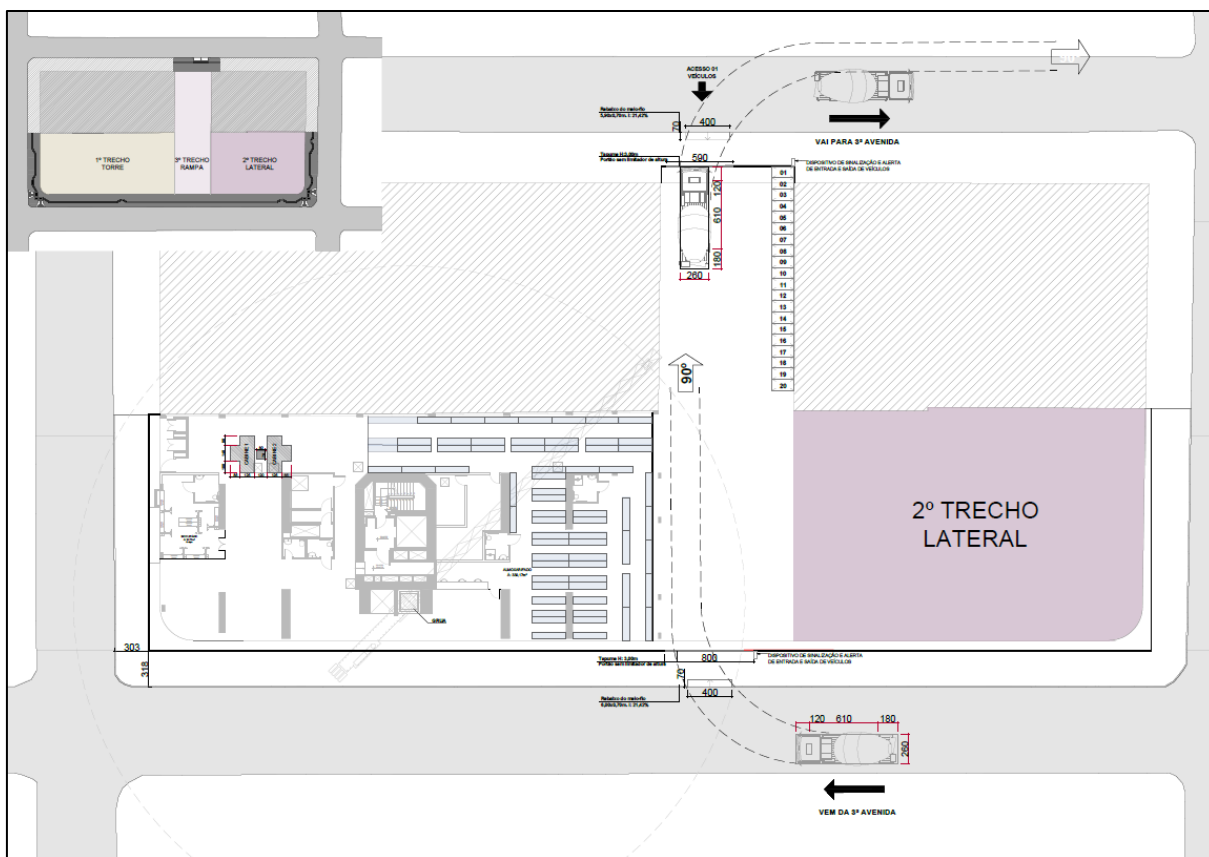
Implantação da segunda fase do canteiro de obras – Raio de Giro conforme AASHTO
